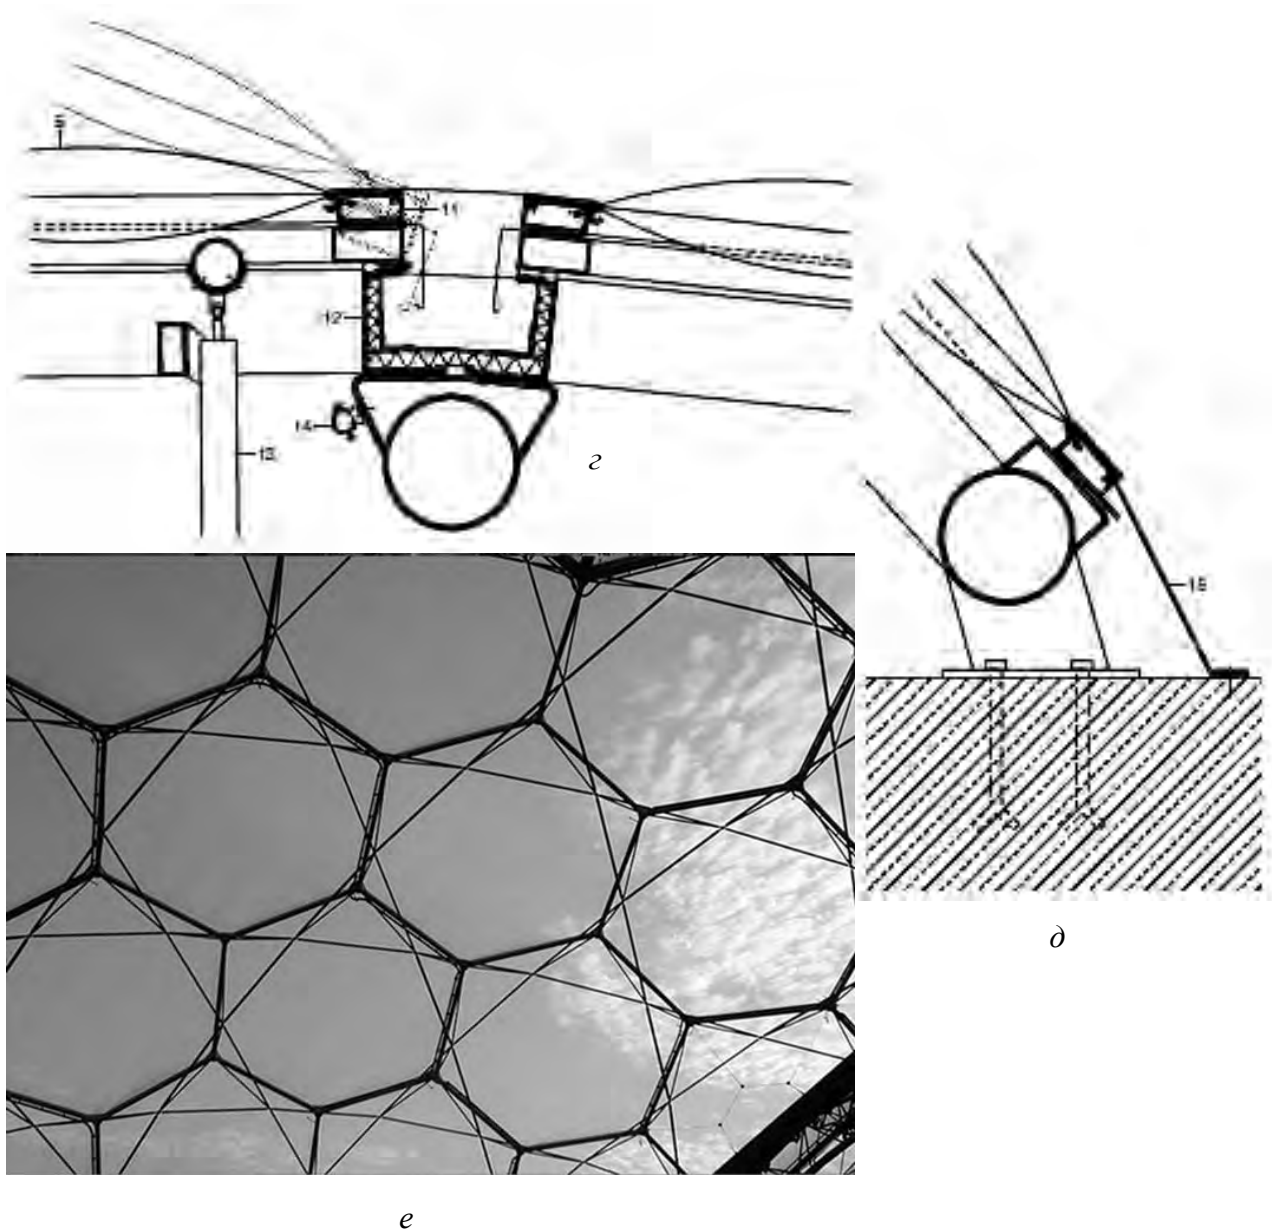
a* – узел желоба и системы открывания; *b* – опорный узел; *c* – укрупненная ромбовидная сетка внутренней решётки; 1 – треугольная решетка объёмной арочной фермы, состоящая из стальных труб диаметром 219, 1\159, 6\101,6 мм; 2 – ПВХ вентиляционные каналы с полиэтиленовыми креплениями; 3 – стальной гнутый профиль $\delta = 6$ мм; 4 – утеплённые алюминиевые панели желоба с герметизирующей обшивкой; 5 – 10 мм стальной кронштейн для крепления желоба; 6 – трехслойные надувные подушки из ETFE-плёнки; 7 – алюминиевая клемма; 8 – стальной цилиндр, $\varnothing = 70$ мм; 9 – литой стальной узел; 10 – стальная диагональная труба, $\varnothing = 89$ мм; 11 – прессованный алюминиевый каркас для поворота клапана; 12 – композитный листовой металл – пластик желоба, утеплитель, стальной профиль; 13 – пневматический цилиндрический открывающий вал; 14 – труба, находящаяся под высоким воздушным давлением, для работы клапана; 15 – лента ПВХ, закреплённая по краям
